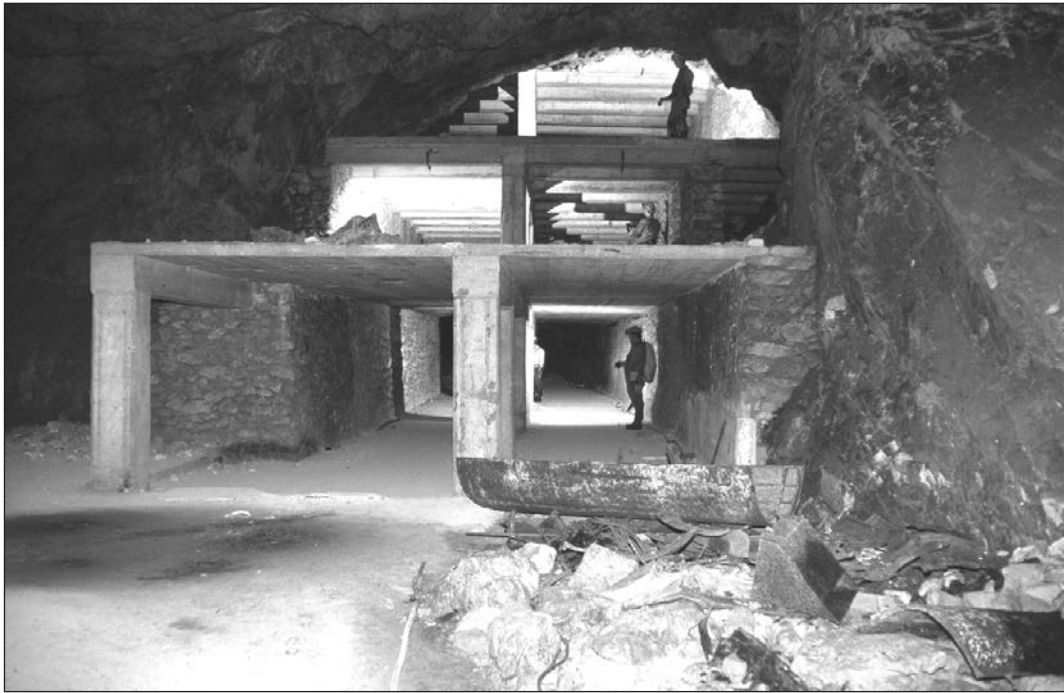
Reste der Fabrikanlagen in der Messerschmitthalle (Bergbau Falkenstein), Foto Hanneberg.
